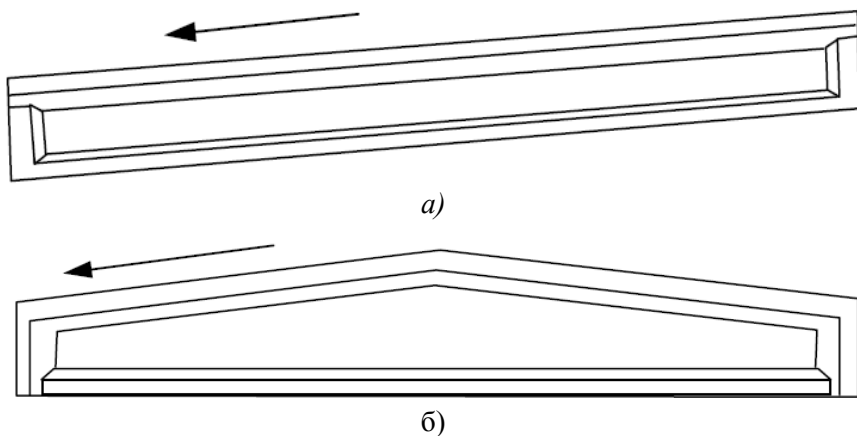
Железобетонные балки: а – железобетонная балка для односкатных покрытий; б – железобетонная балка для двускатных покрытий
